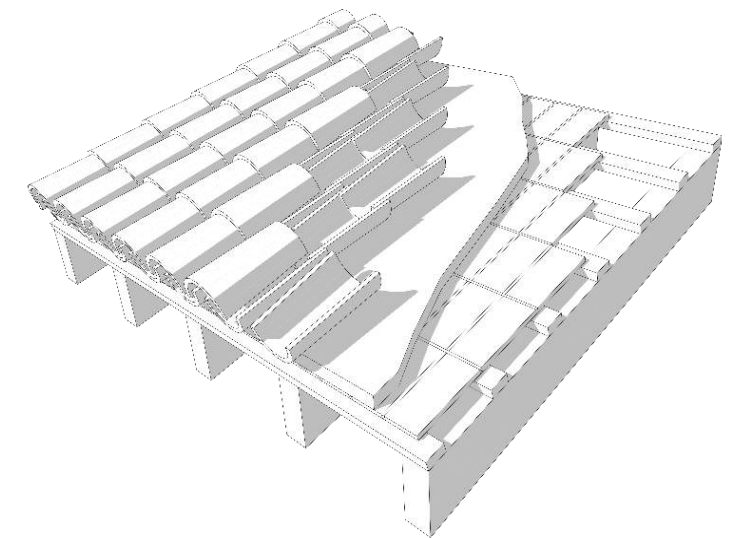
Detalle constructivo de Cubierta. Autor Propio. 2015
